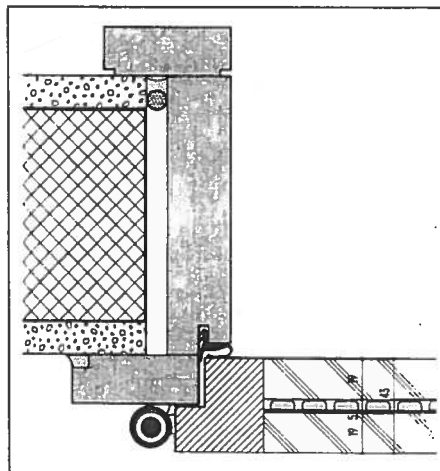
Türelement in Sandwichbauweise mit Hawaphon-Beschwerung.
